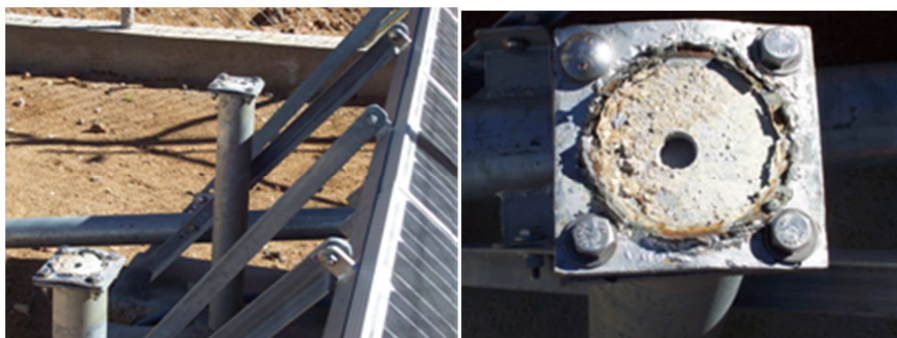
Rotura en columna de estructura soporte por fallas en las soldaduras.
